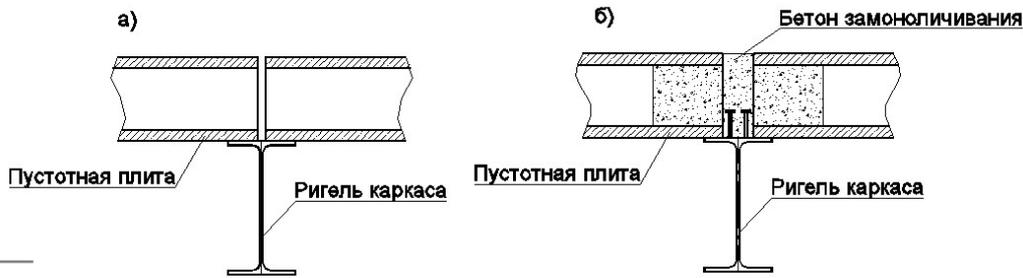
Варианты перекрытий зданий со стальным каркасом с применением сборных плит:
